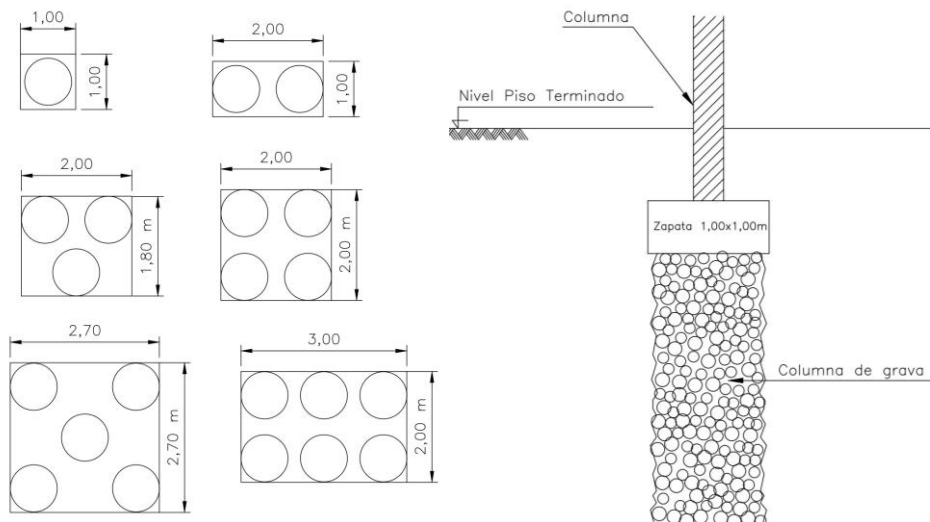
Plantas y sección tipo de zapatas sobre columnas de grava.
